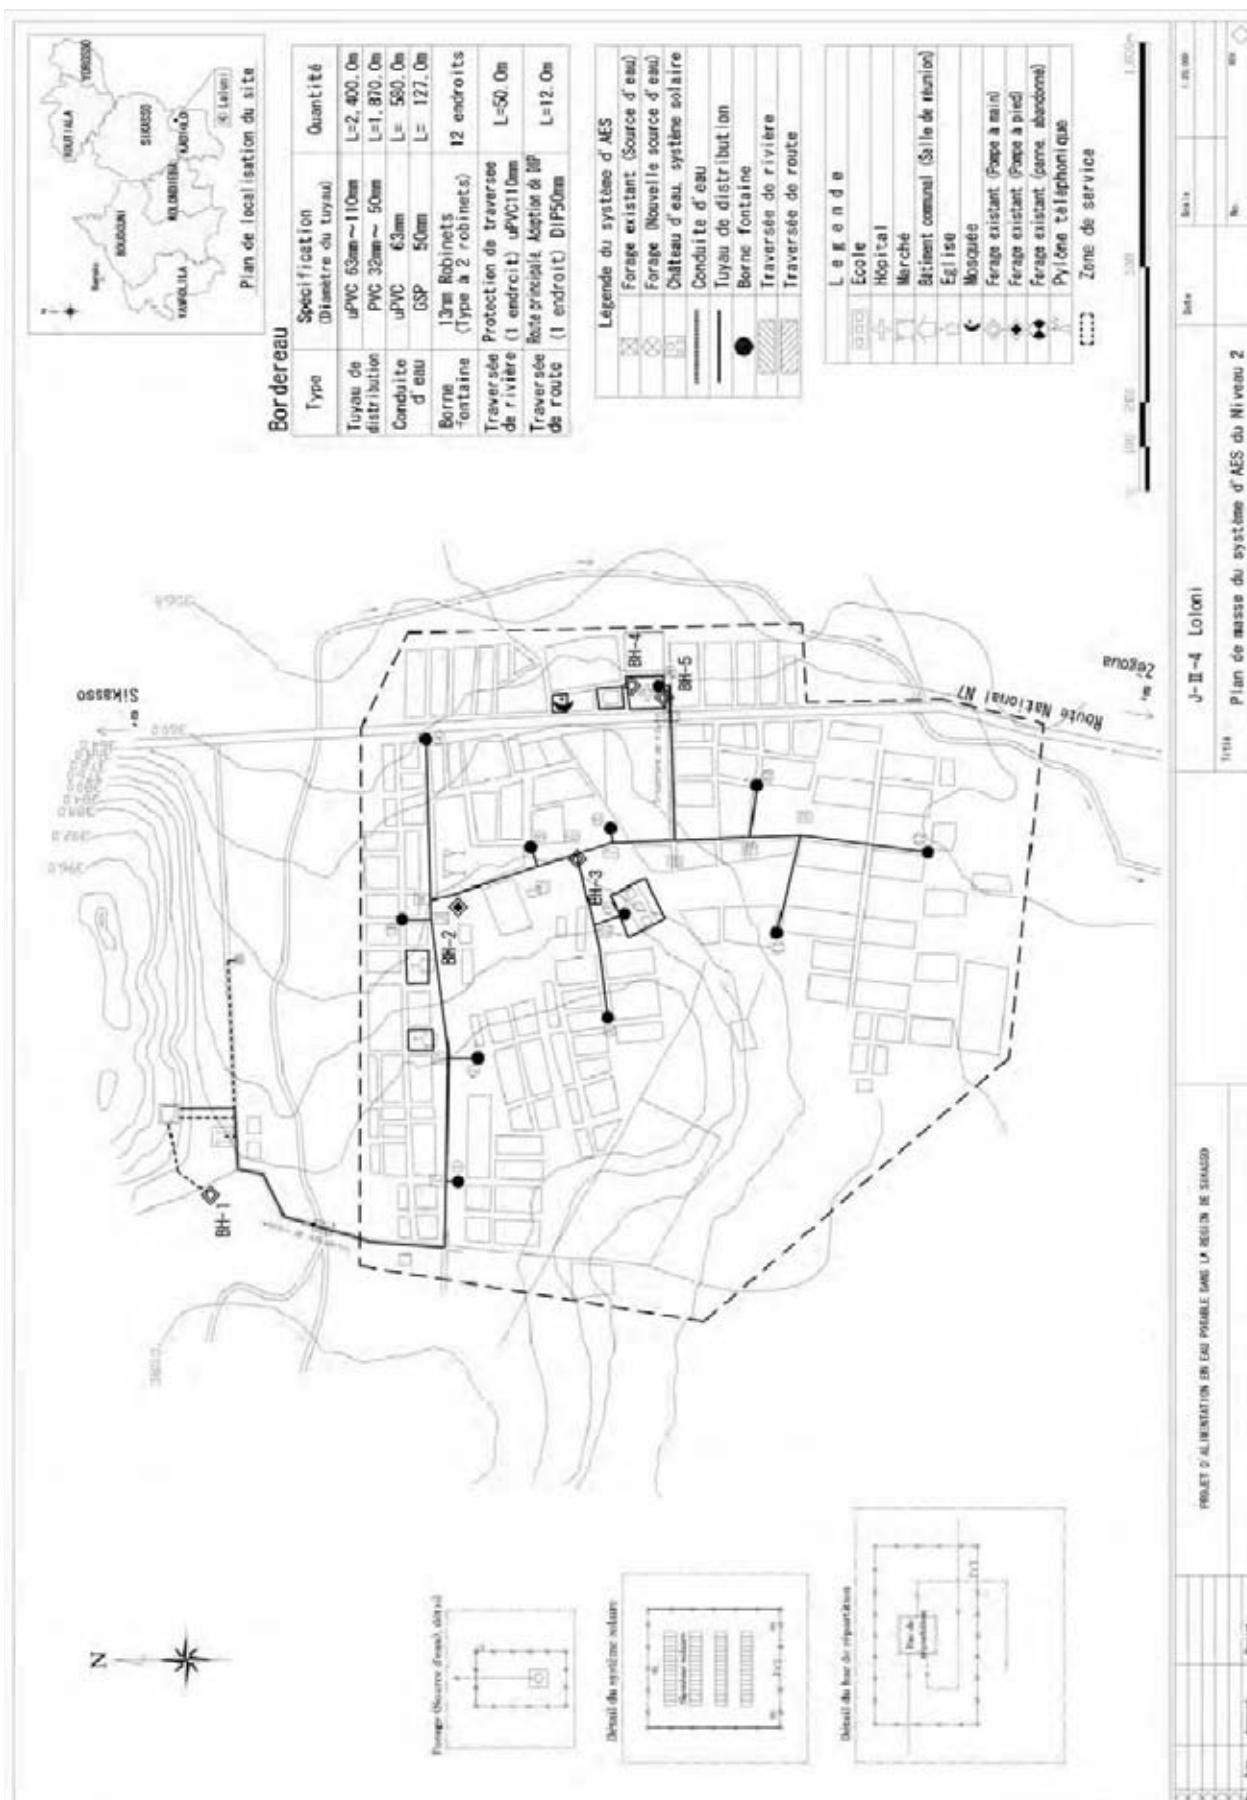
Plan de masse du système d'AES du Niveau 2 (J-11-4 Loloni)
